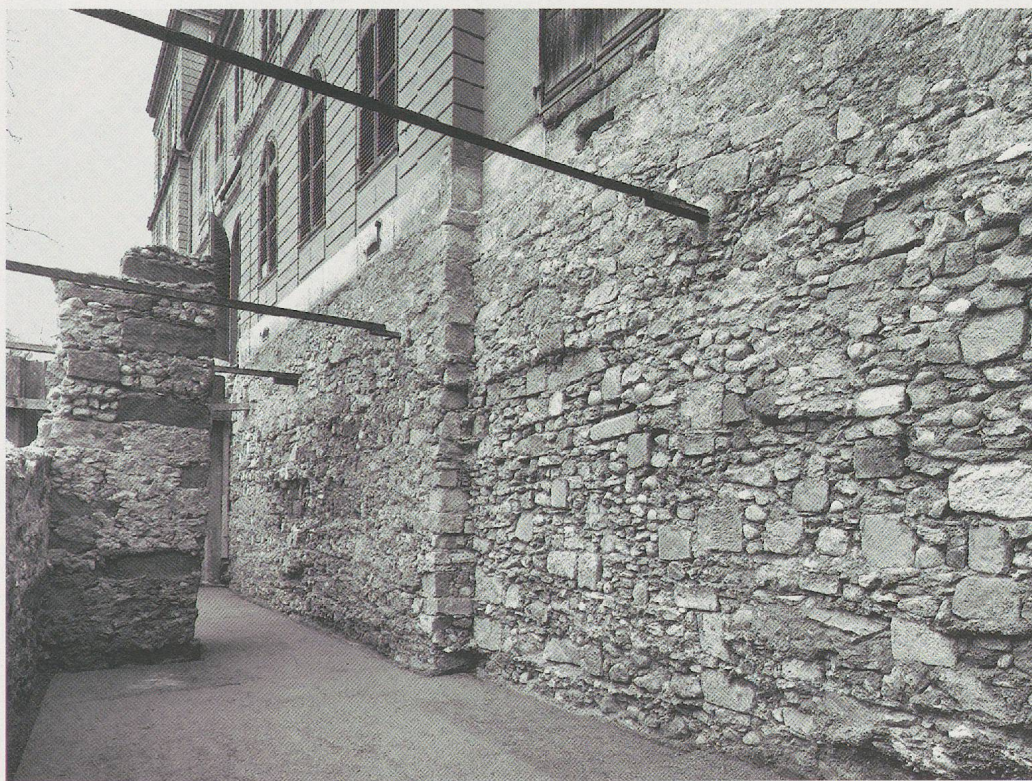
La fondation du château sous la terrasse est, avec à gauche le massif d'ancrage VI³ du premier mur de terrasse.
